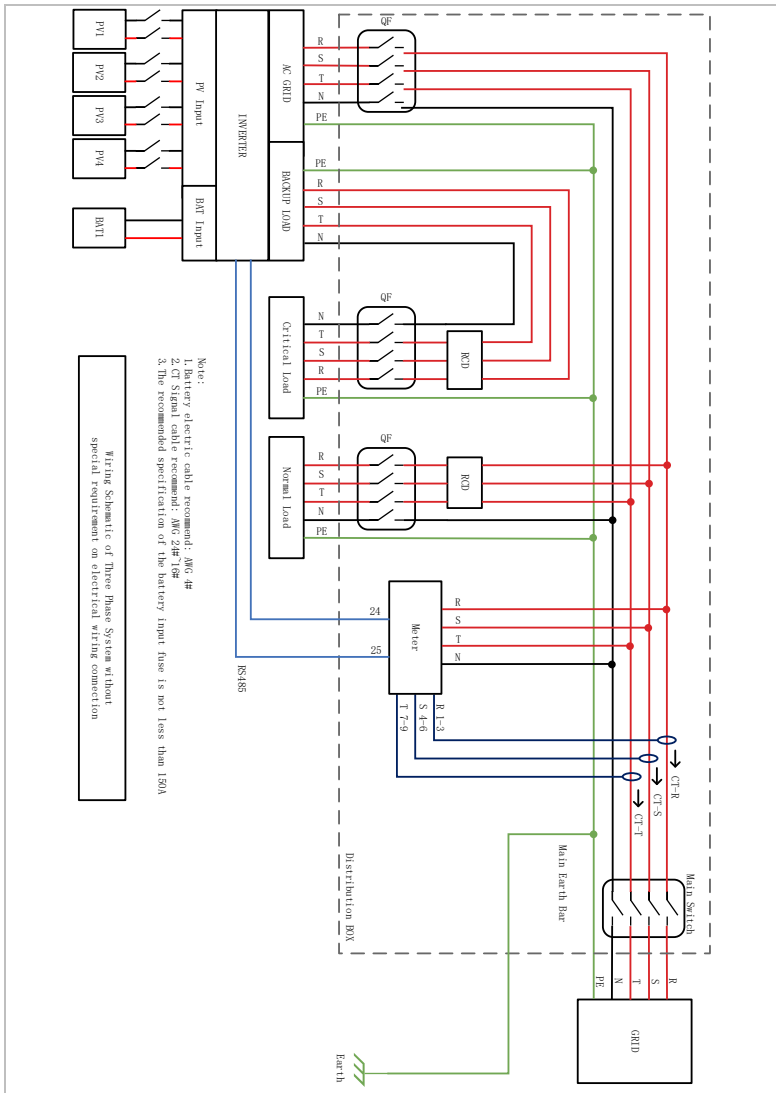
4 Conexiones eléctricas (Plan B: Contador + TC)
